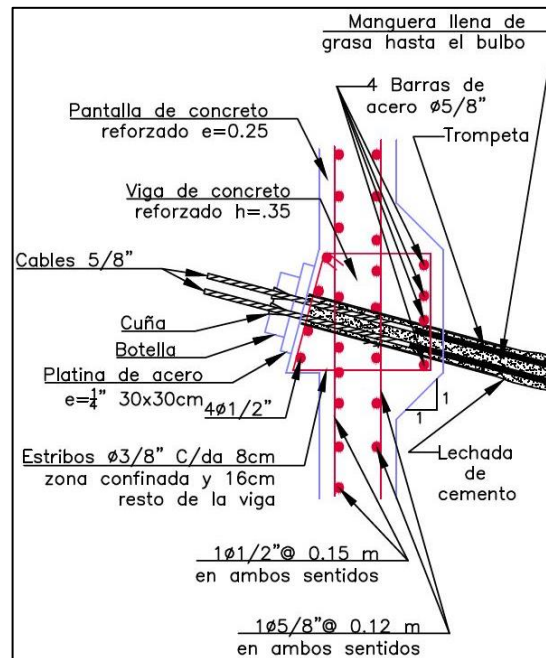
Detalle Anclaje Pretensionado 40 Ton
